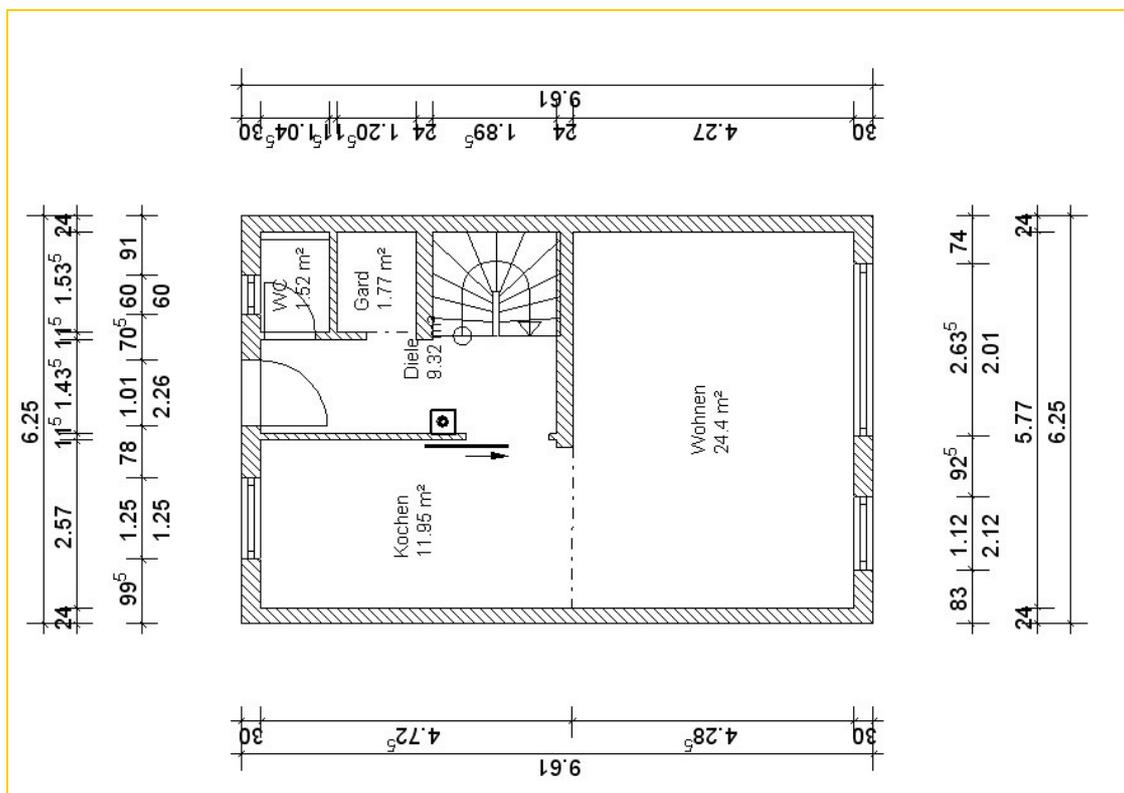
Grundriss Reihemittelhaus EG
